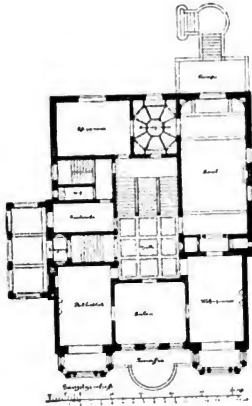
und 484. Wohnhaus Frerichs, Osterdeich 27. Fassade und Grundriss. J. Poppe. 1892.
